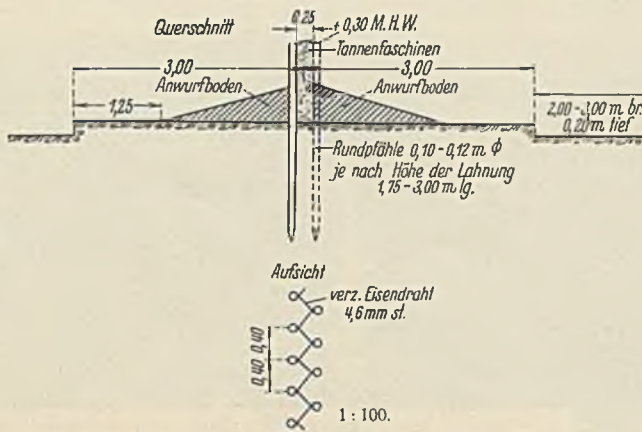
Querschnitt und Grundriß eines Schlickfängers.
